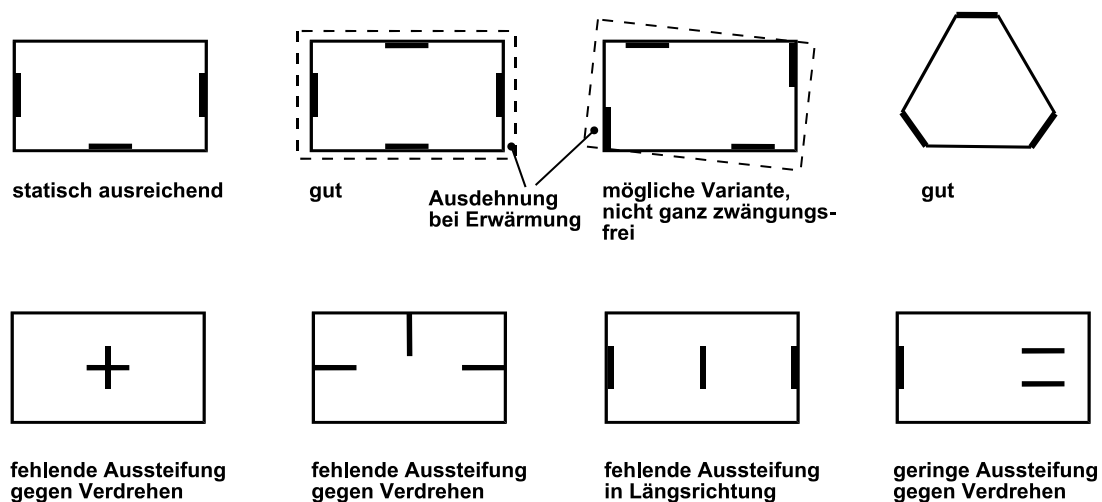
Günstige und ungünstige Anordnung von Aussteifungswänden im Grundriss (nach [21])
